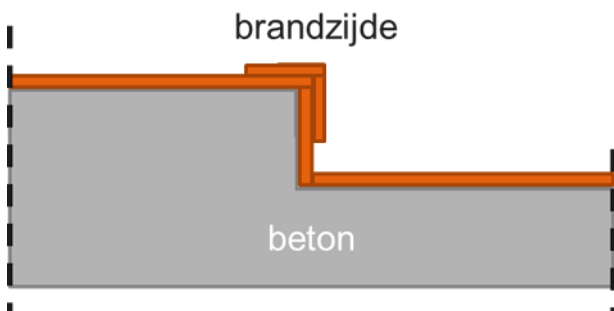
Afwerklaag aangebracht voor Aestuver-Tx beplating met elementen van Omeras in de Wiltener tunnel in Oostenrijk.
